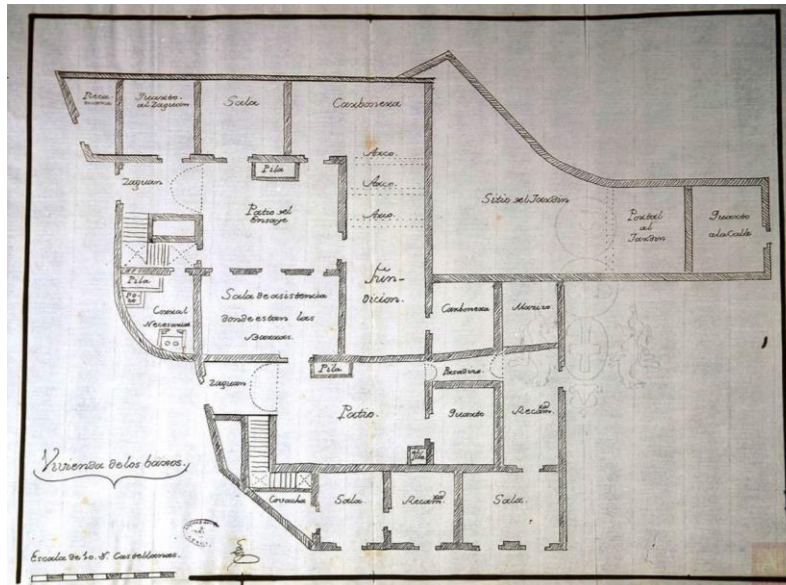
Plano planta baja original Casa del Real Ensaye 1786.
